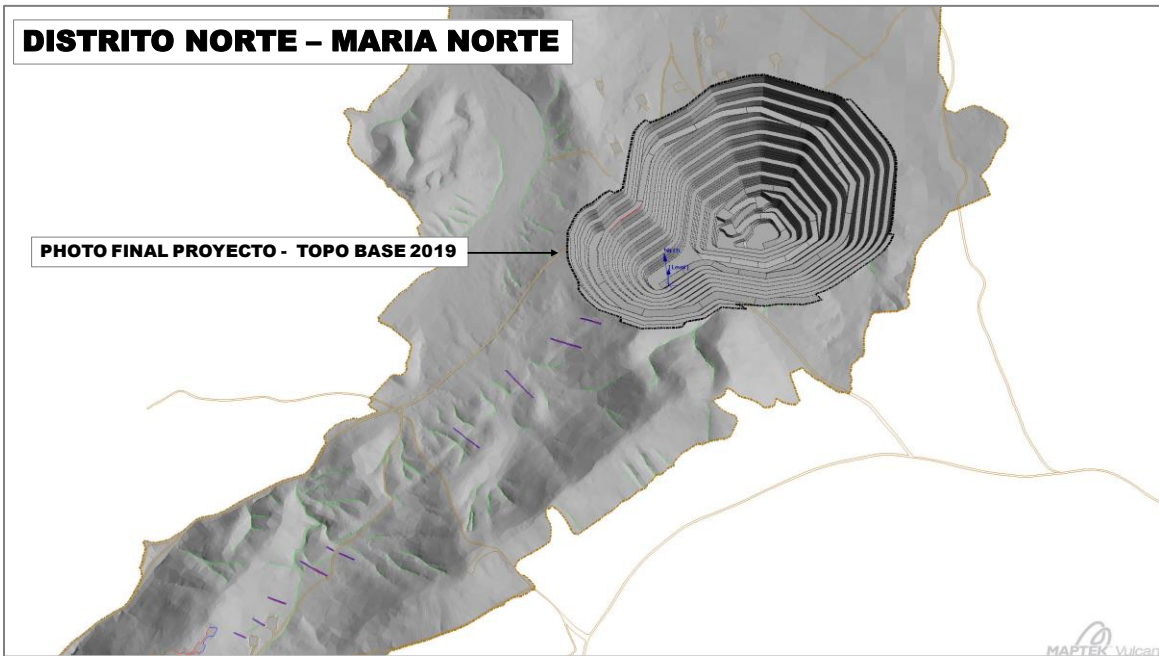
Foto pit final proyecto Mina Distrito Norte María Norte.
